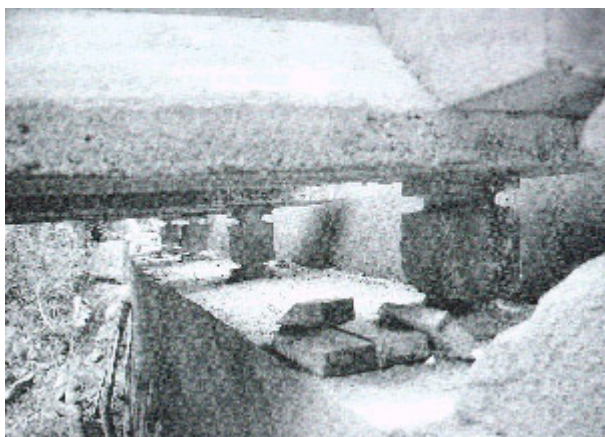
Rotulas Freyssinet del puente de Teosinte. Guillermo Candela García. Revista de Obras Públicas 3.346 (9): 73-81. 1995.
